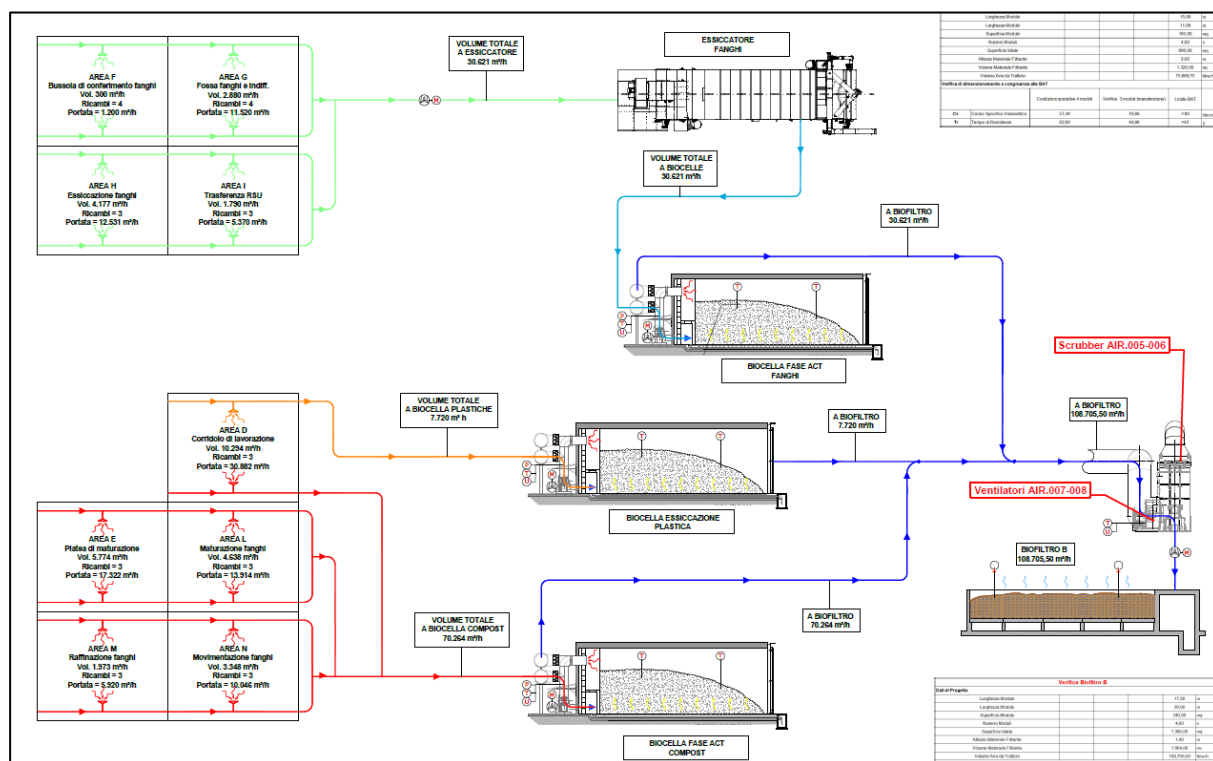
Schema aria biofiltro 1 – Stralcio Allegato n. 8 – Schema rete aria
